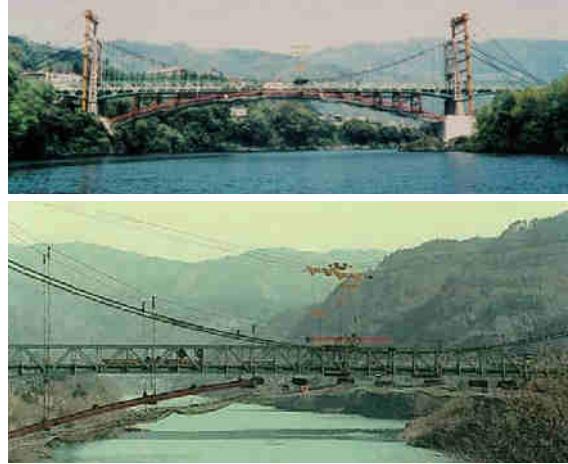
ケーブルエレクション工法によるアーチ橋の施工(写真下) (大岩義雄氏提供)
